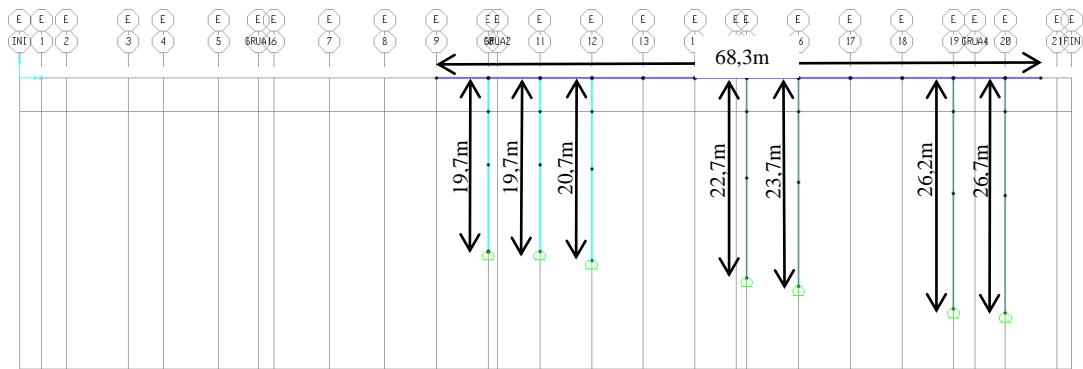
Vista en elevación del plano E de geometría, paralelo a plano X-Vertical'.
